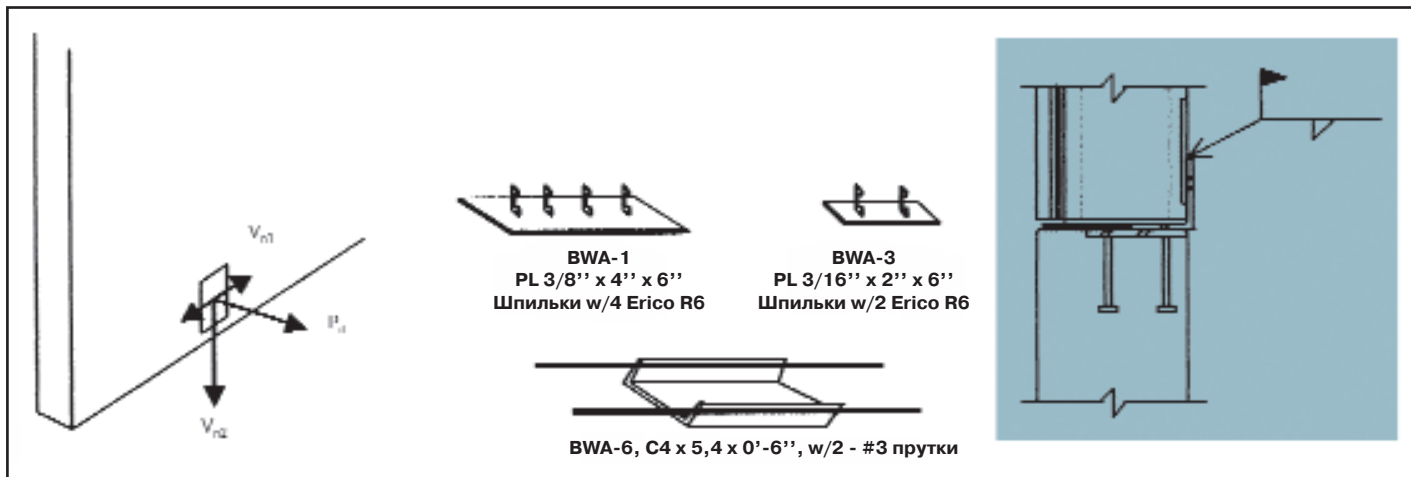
Конструкция опорного соединительного узла стенопанели.
